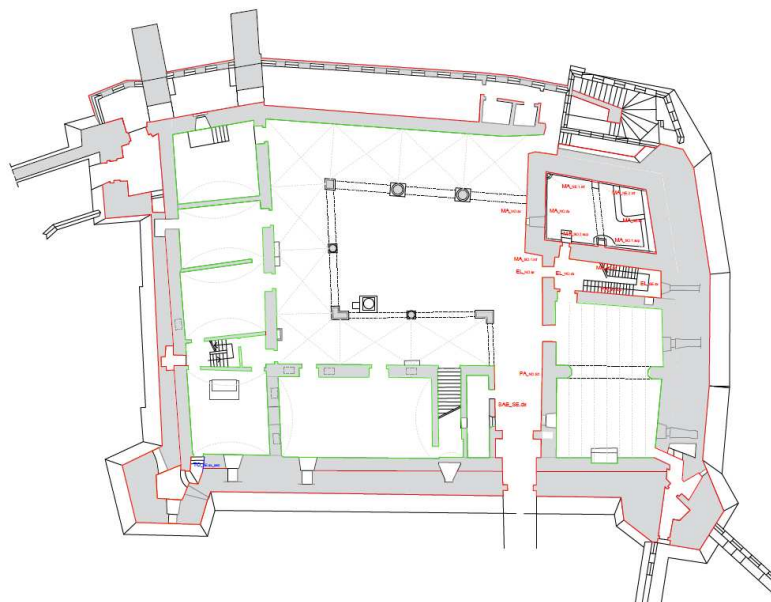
Individuazione dei paramenti analizzati nella pianta del piano terra, dove in rosso sono evidenziate le pareti tessite, in verde le pareti intonacate e in blu le sezioni a vista
